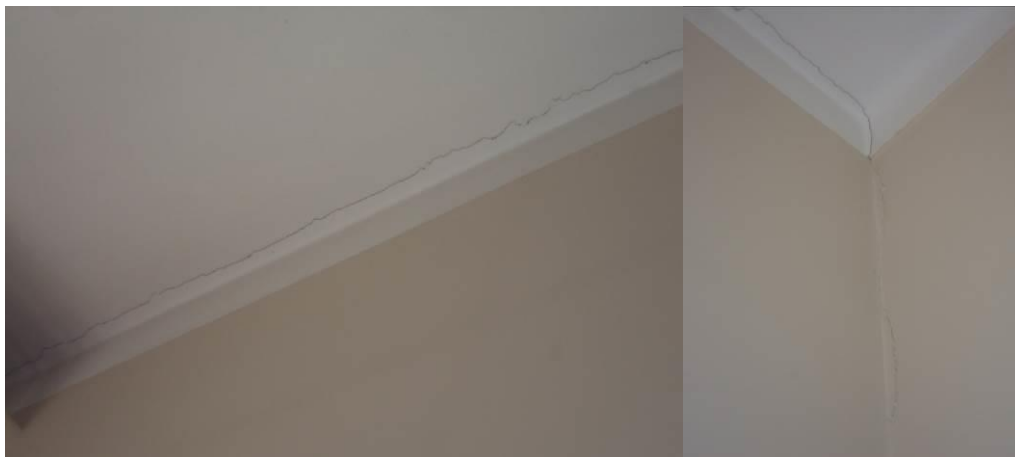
Fissuração do revestimento da parede do gabinete
